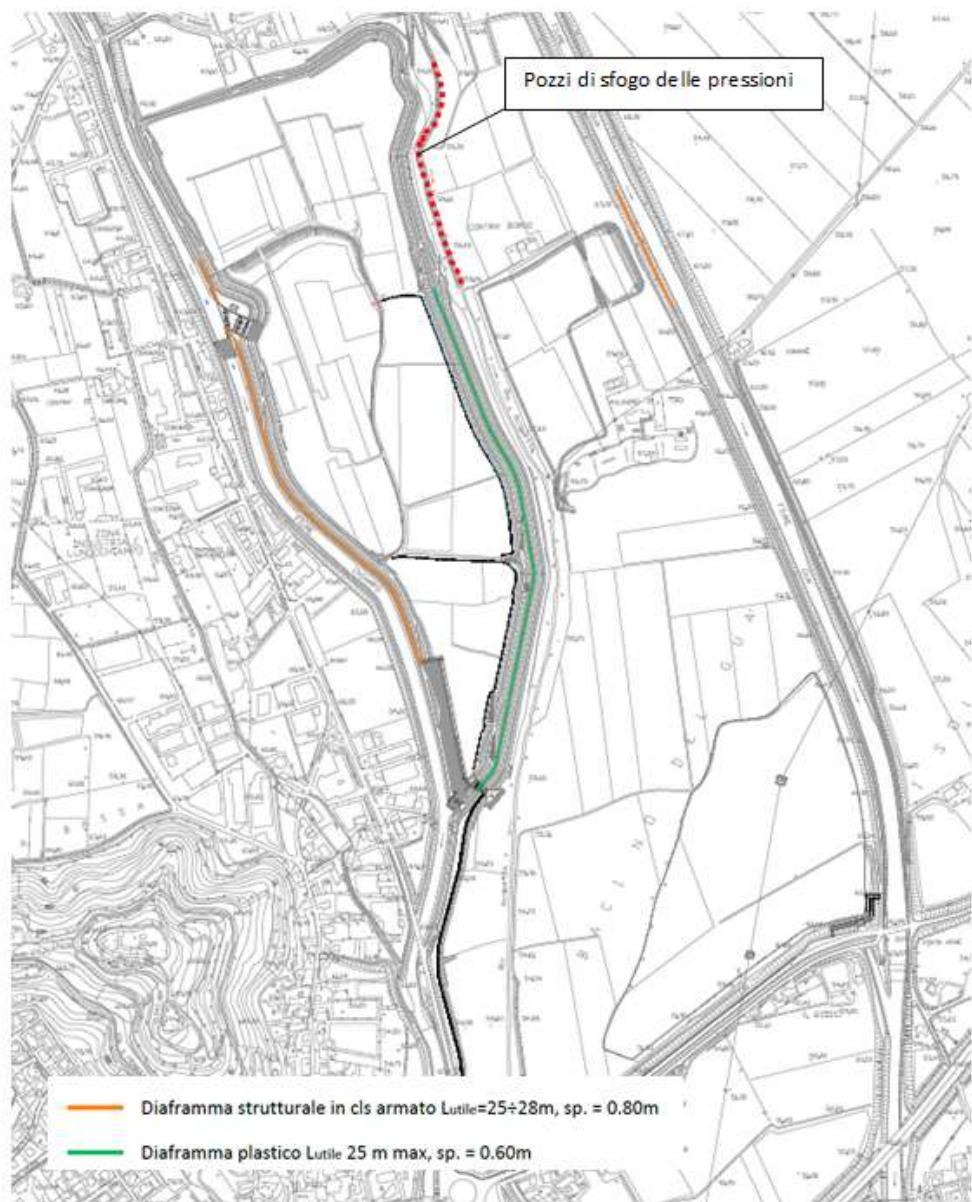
Planimetria con ubicazione dei diaframmi arginali
